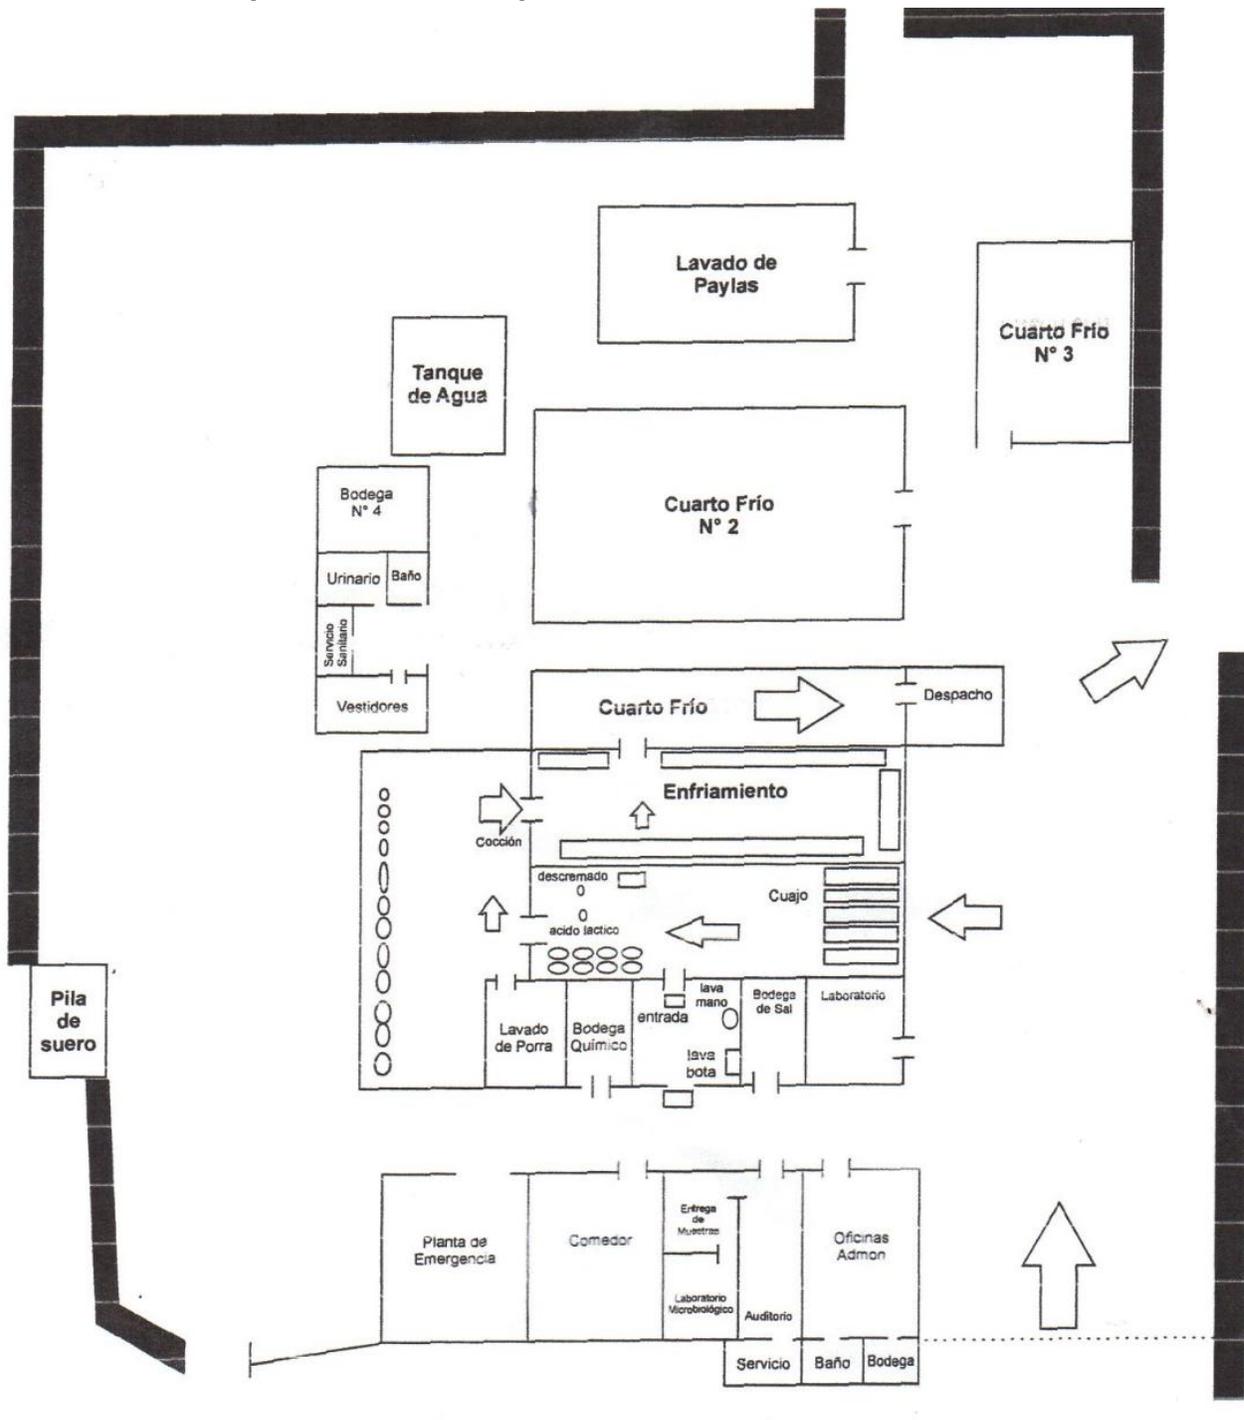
Plano arquitectónico de la planta Lácteos "Las Tucas"
